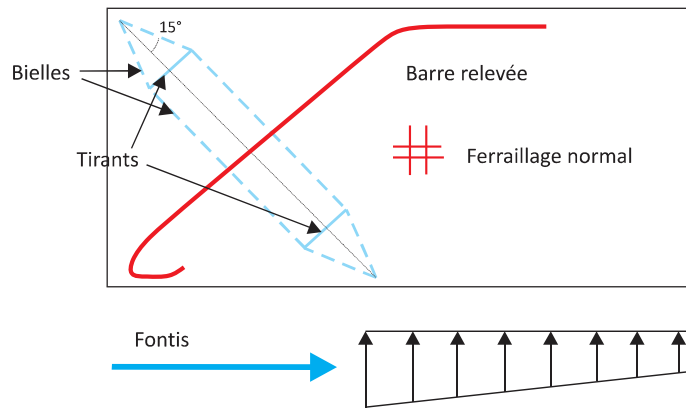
Exemple d'un renfort à l'extrémité par barres relevées
